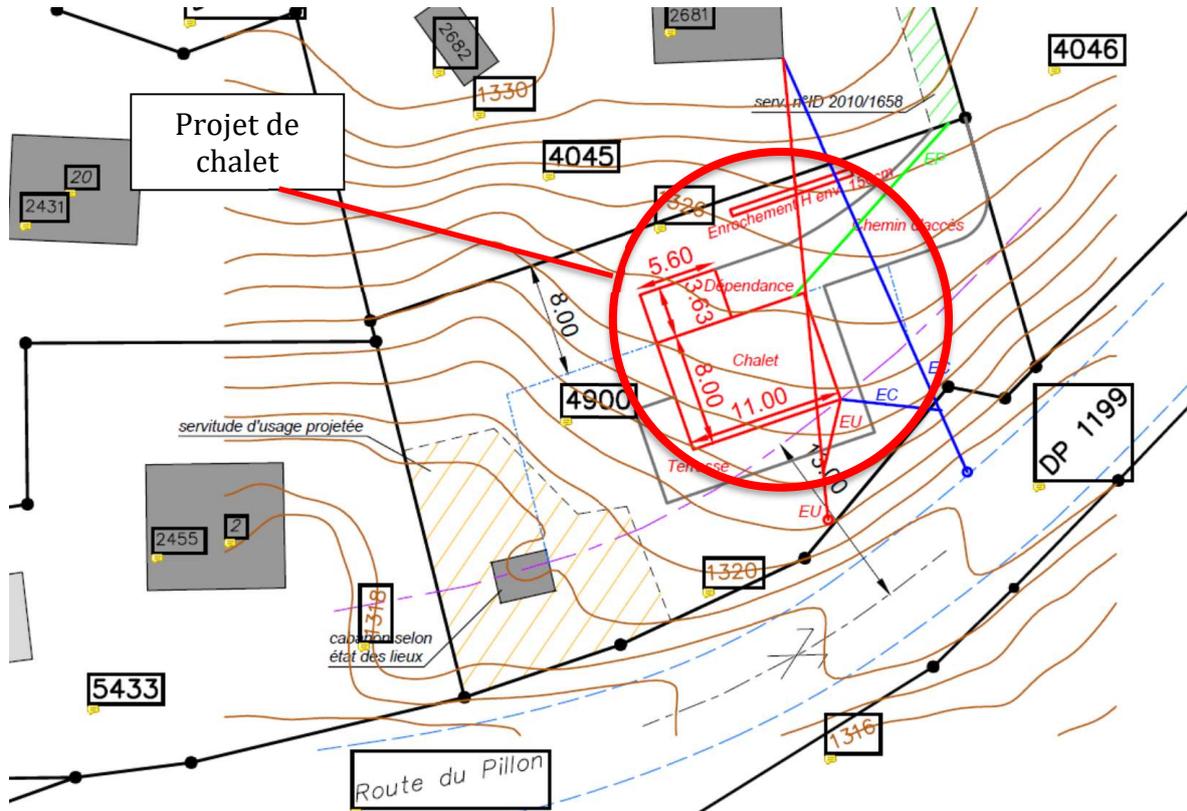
Extrait plan de situation de l'implantation du chalet prévu - plan reçu le 01.07.24 - sans échelle, Nord vers le haut
